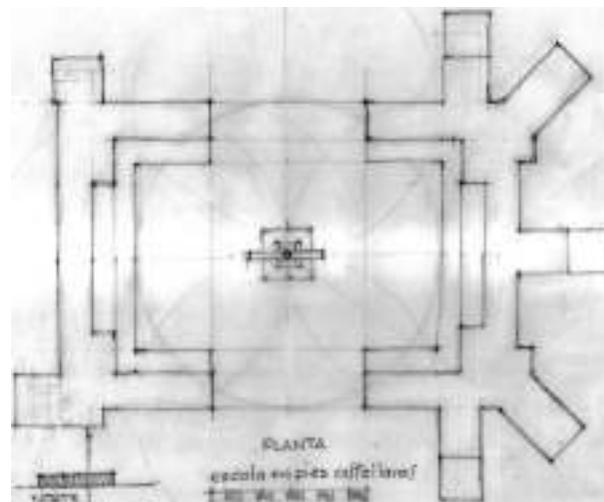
Planta “cámara de los secretos”, escala 10 pies.
